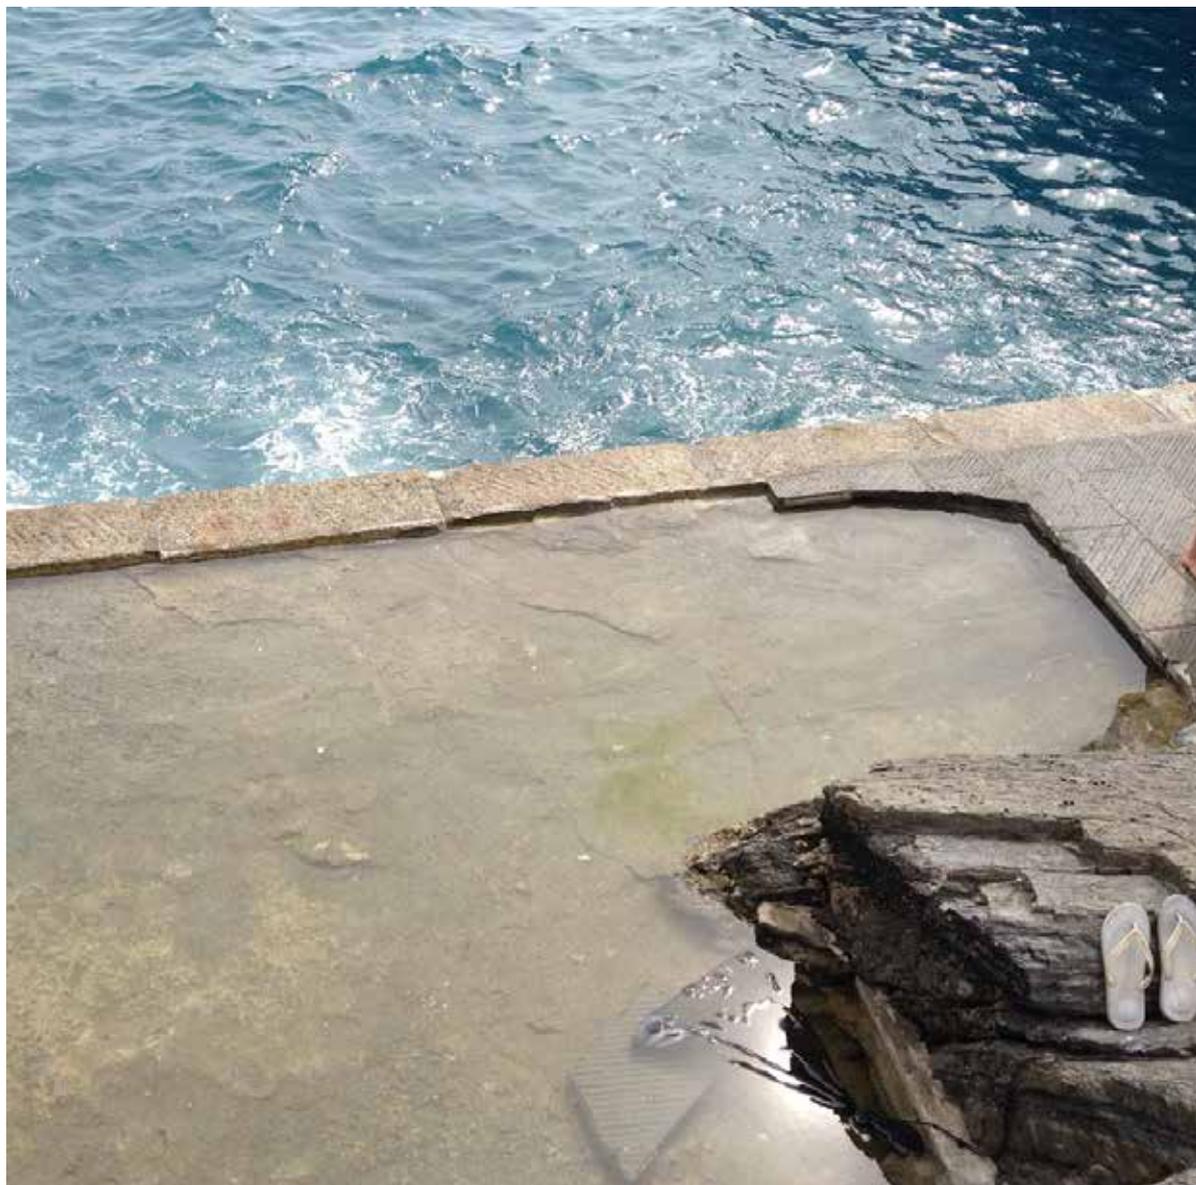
La pavimentazione di Ventegà dopo l'alluvione
